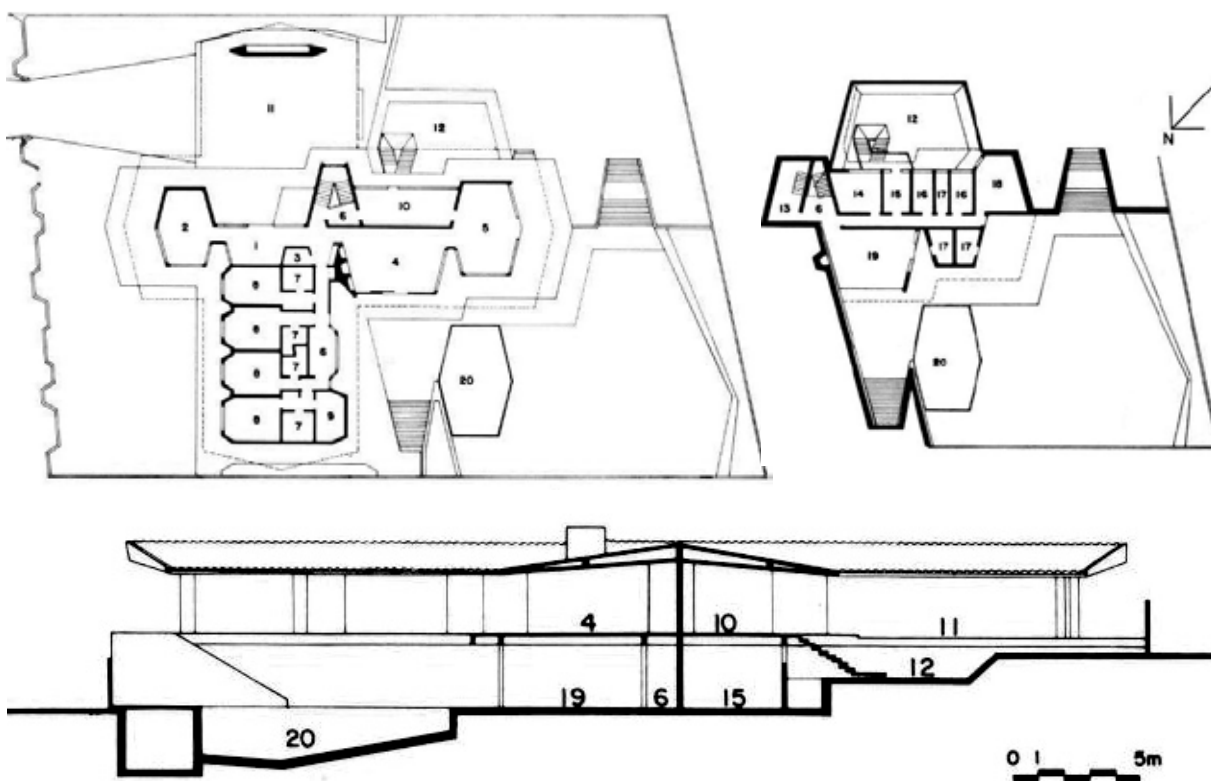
Casa Leo Grossman; planta pavimento térreo: 1) hall social; 2) biblioteca; 3) lavabo; 4) sala de estar; 5) sala de jantar; 6) circulação; 7) banheiros; 8) dormitório; 9) vestiário; 10) cozinha; 11) abrigo; 12) área de serviço; 13) casa de bombas; 14) casa de máquinas; 15) lavanderia; 16) q. empregada; 17) banheiro; 18) depósito; 19) salão de festas; 20) piscina.
